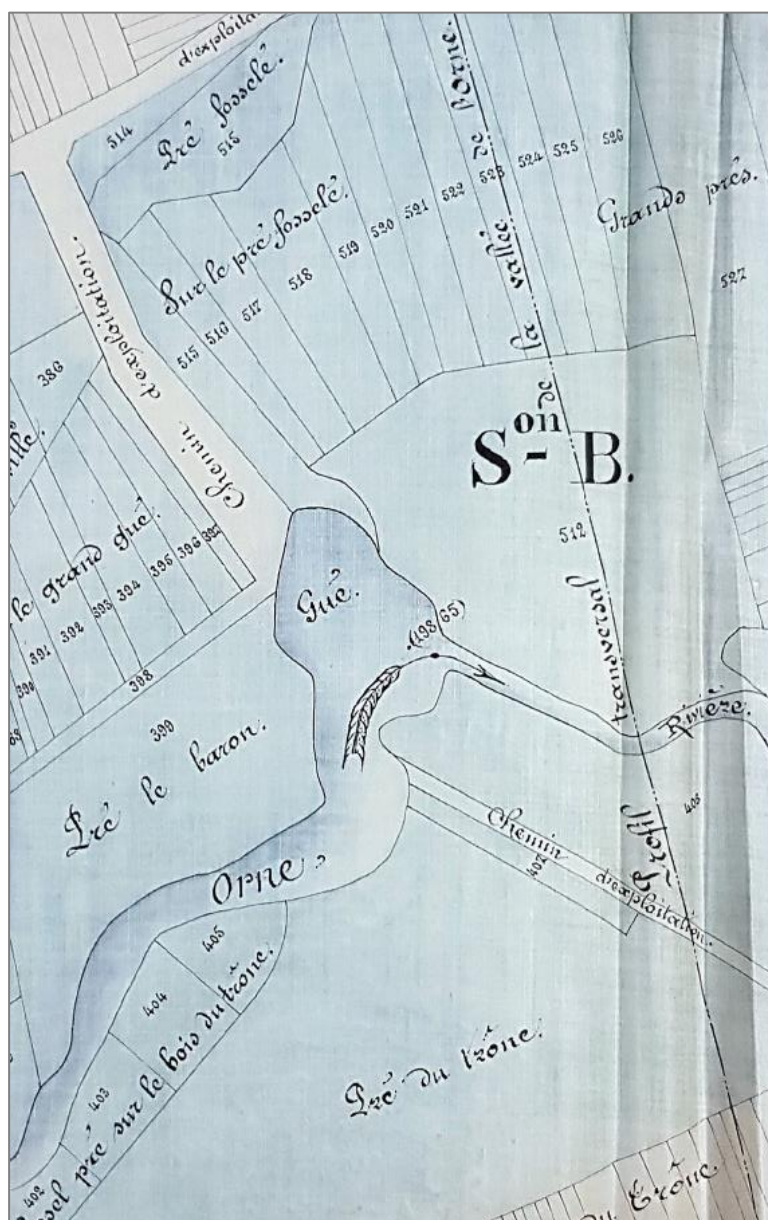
Plan pour la construction d'une passerelle sur l'Orne à Olley. Plan annexé au rapport de l'Ingénieur datant de juillet 1890. (Source : AD54 – 3S88)
